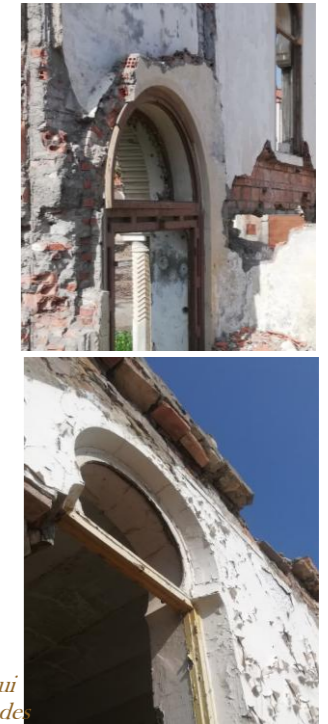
et 4 : photos qui montrent l'encadrement des portes en bois. Source : Auteur.
